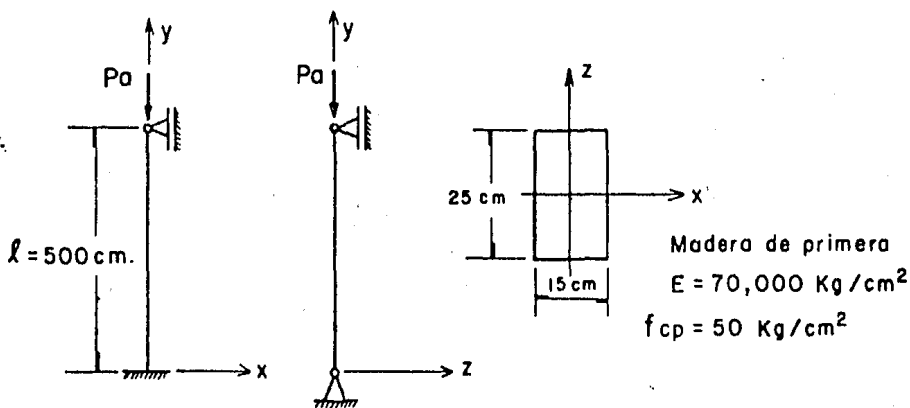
Columna con diferente sistema de apoyo en ambos planos.
